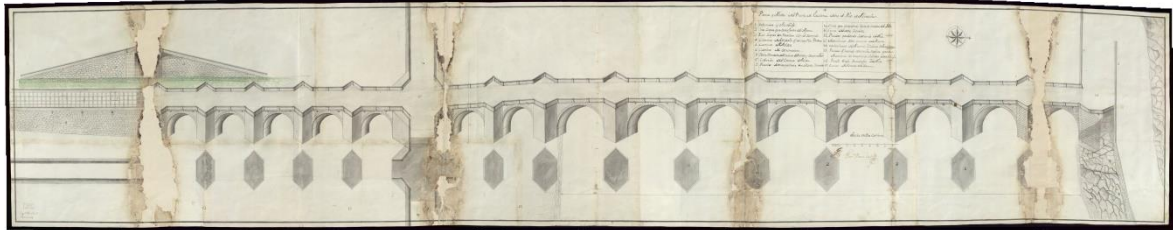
Plano de Planta y Alzado del Puente de Escalona sobre el río de Alberche
